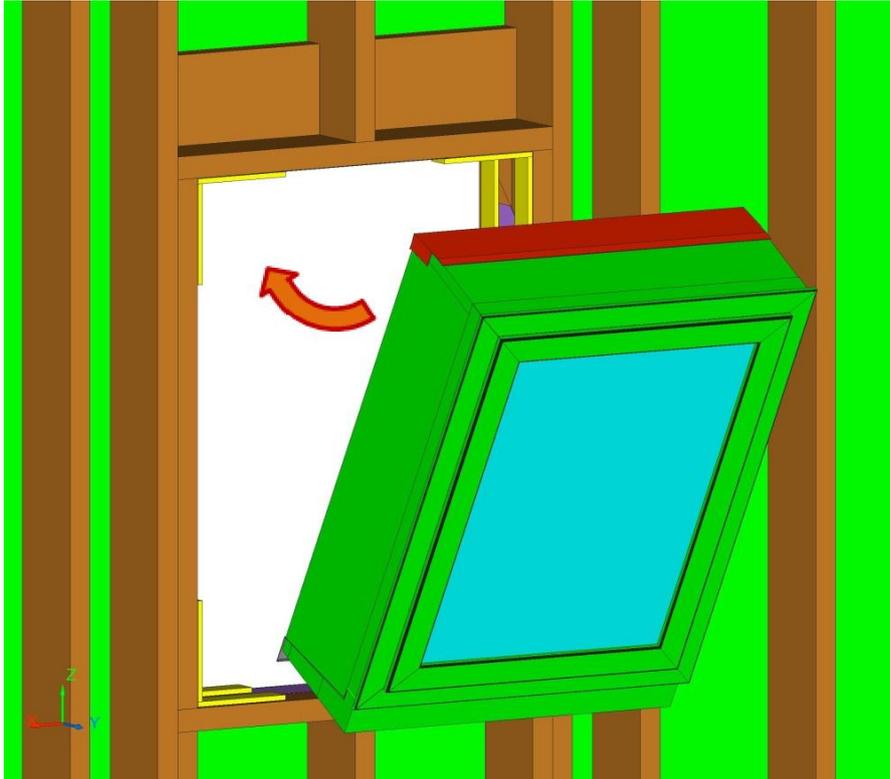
Mise en place en tunnel de la menuiserie avec encadrement de baie intégré
